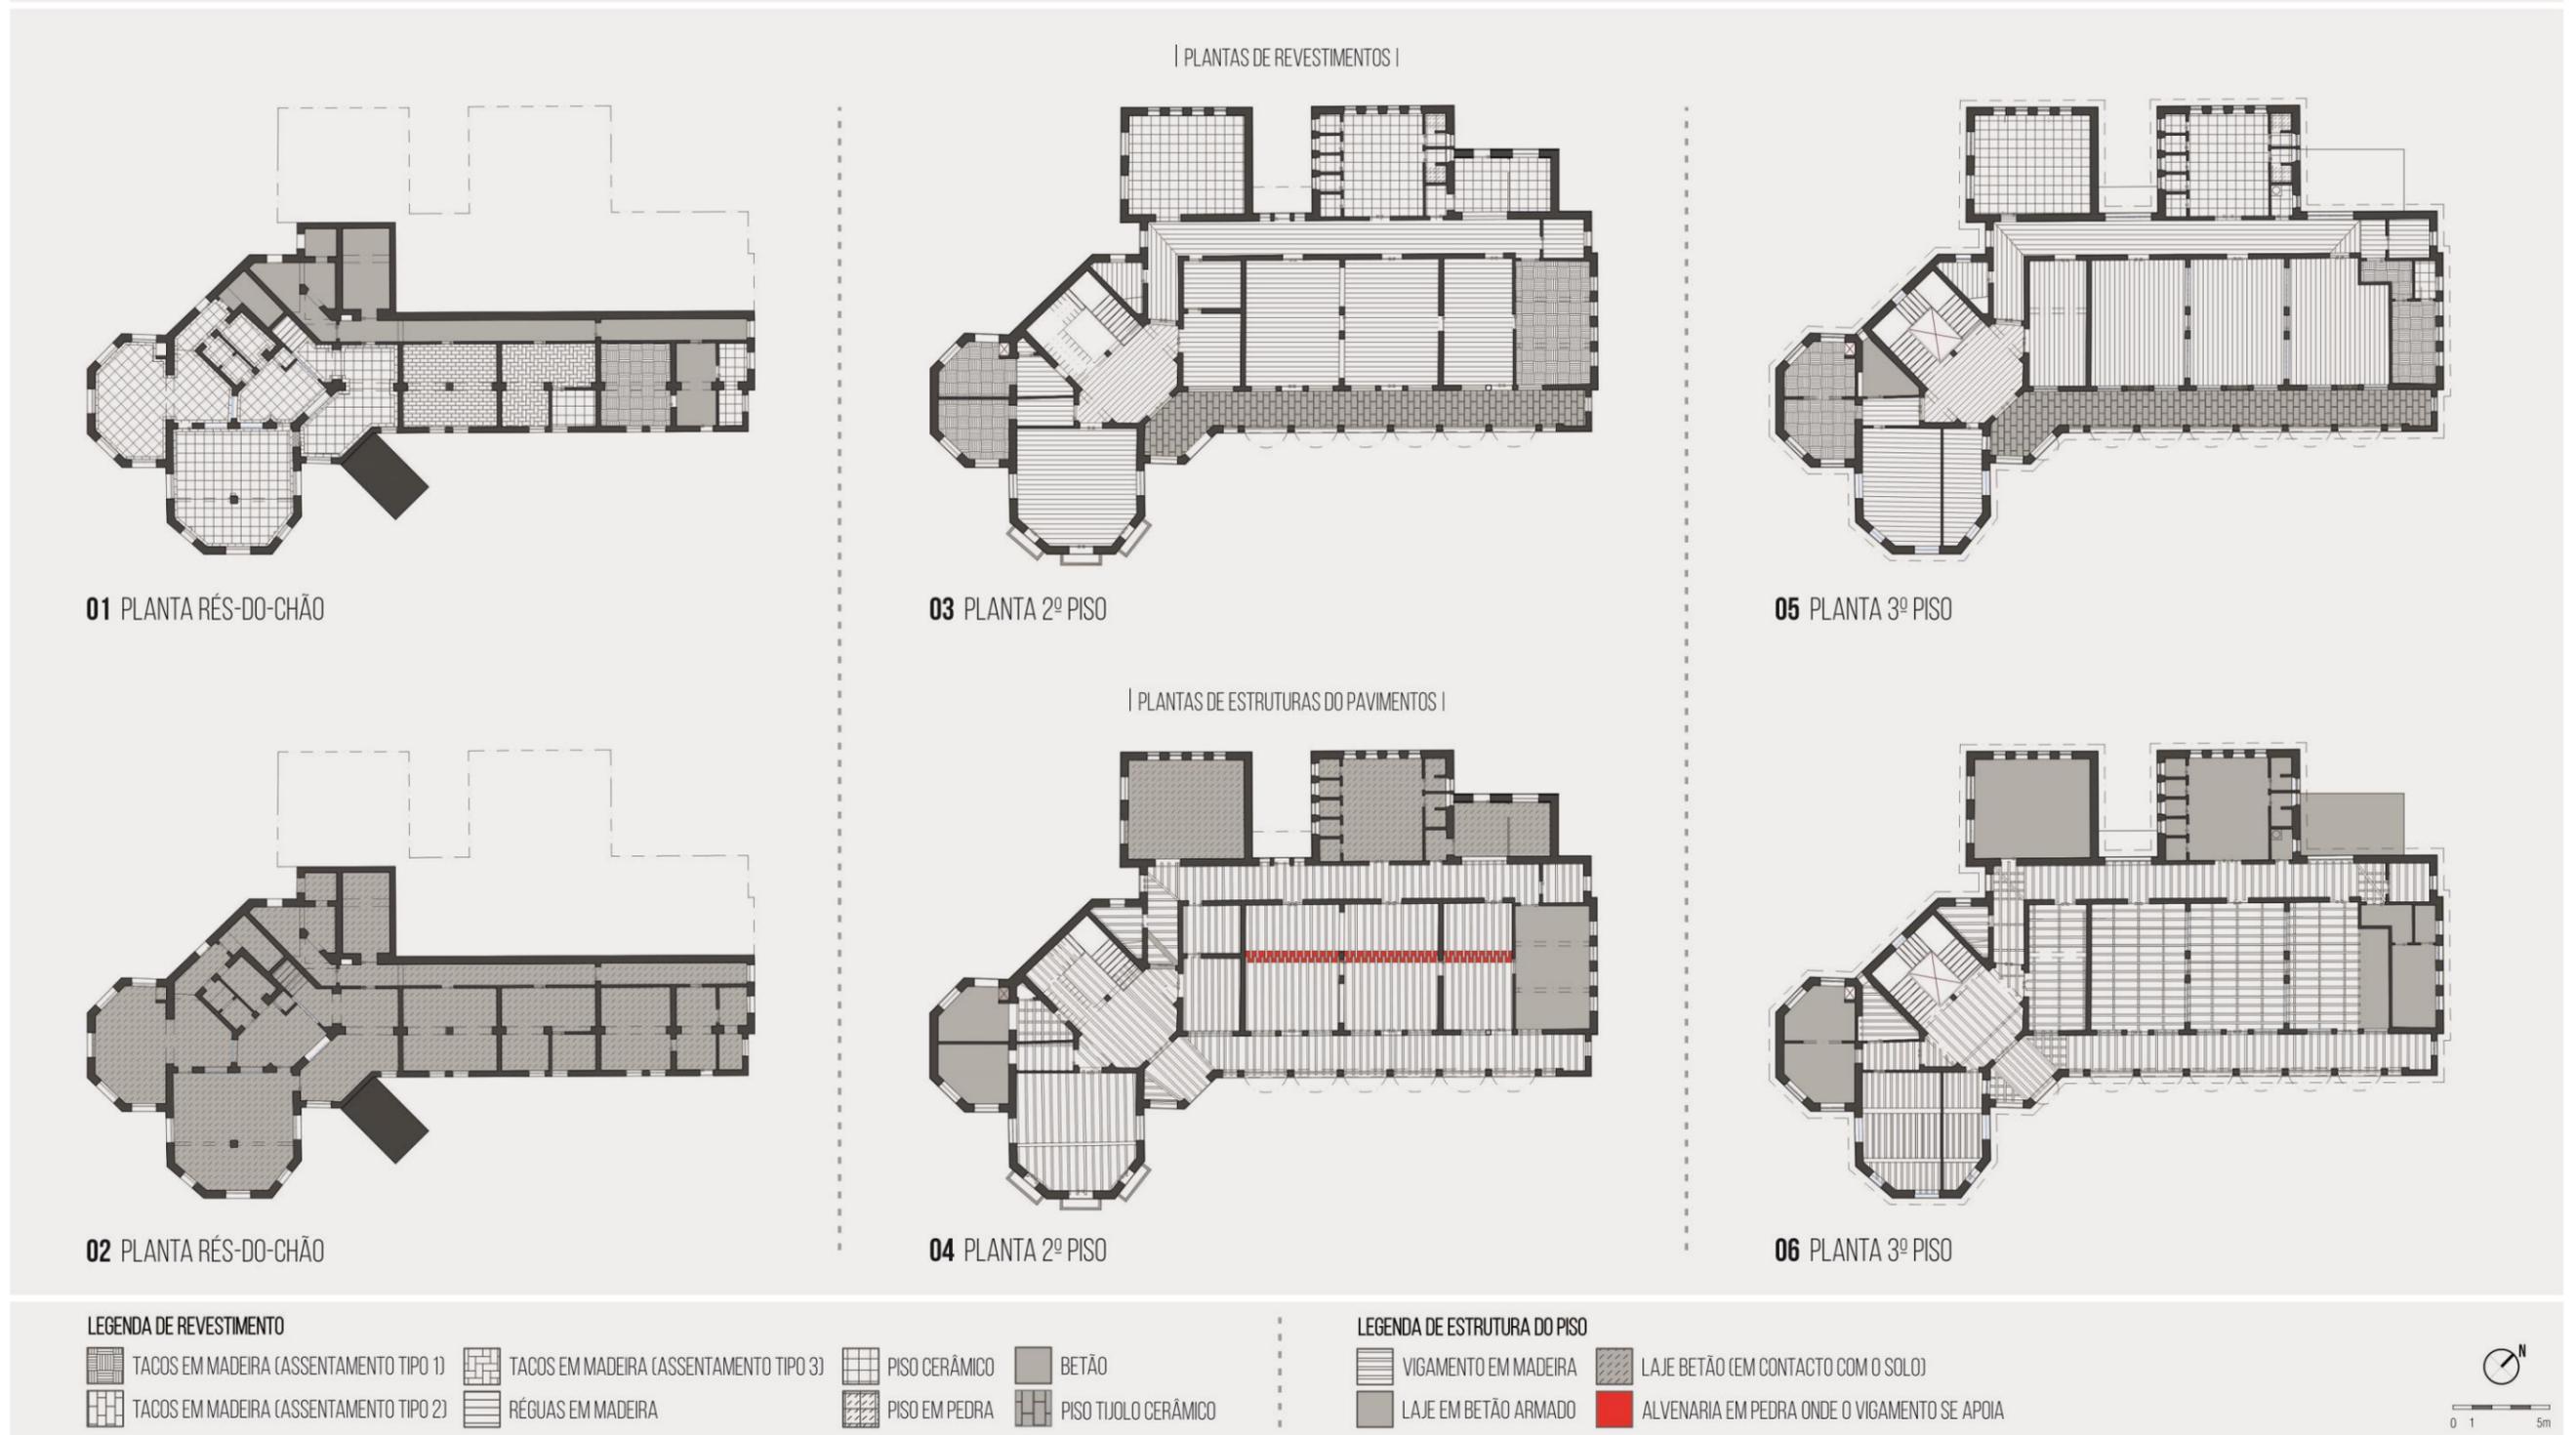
Definição Material – Plantas de revestimentos dos pavimentos – rés-do-chão, 2º e 3º pisos (desenvolvida a partir do levantamento *in situ*)
